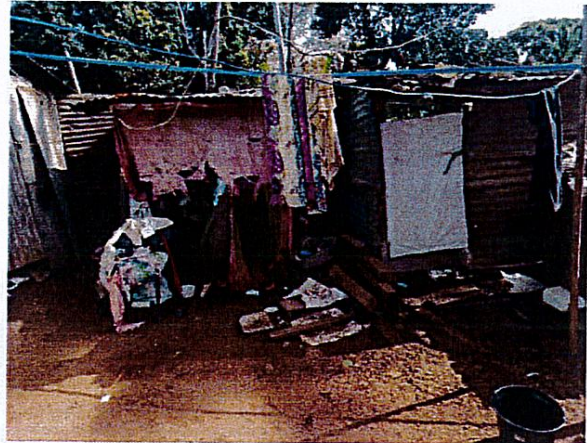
construction formée par assemblage de matériaux hétéroclites en mauvais état, présence de débris.
